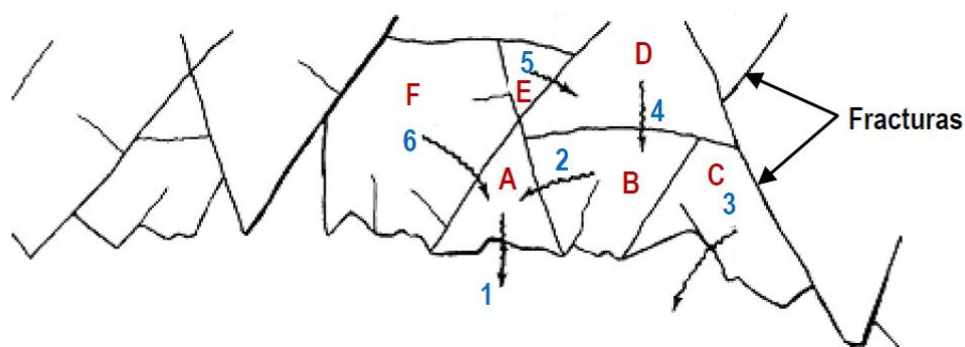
Sección vertical de parte del techo de una galería en una mina subterránea fuertemente fracturada, ilustrando la secuencia de caída (Adaptada de Federal Highway Administración, 2011).
